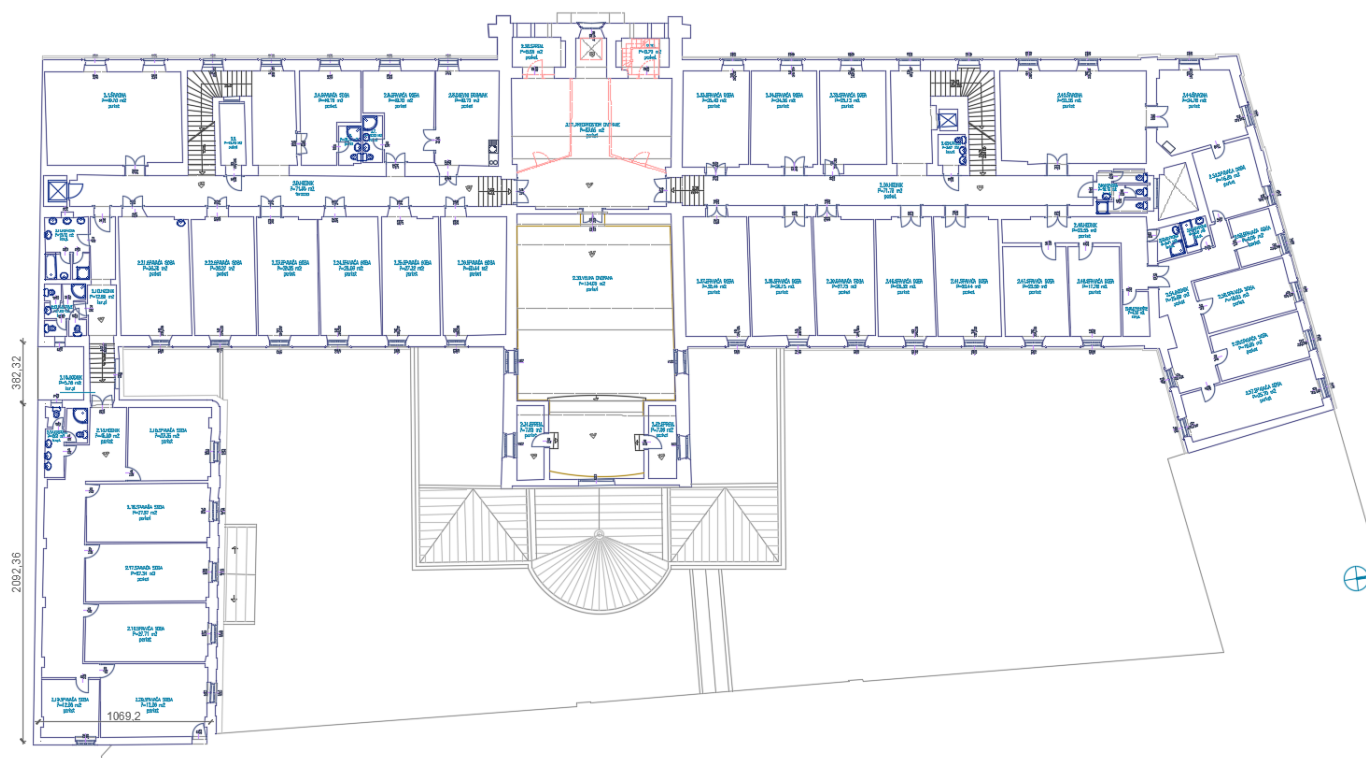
Tlocrt podruma i prizemlja (-1.95 m)
